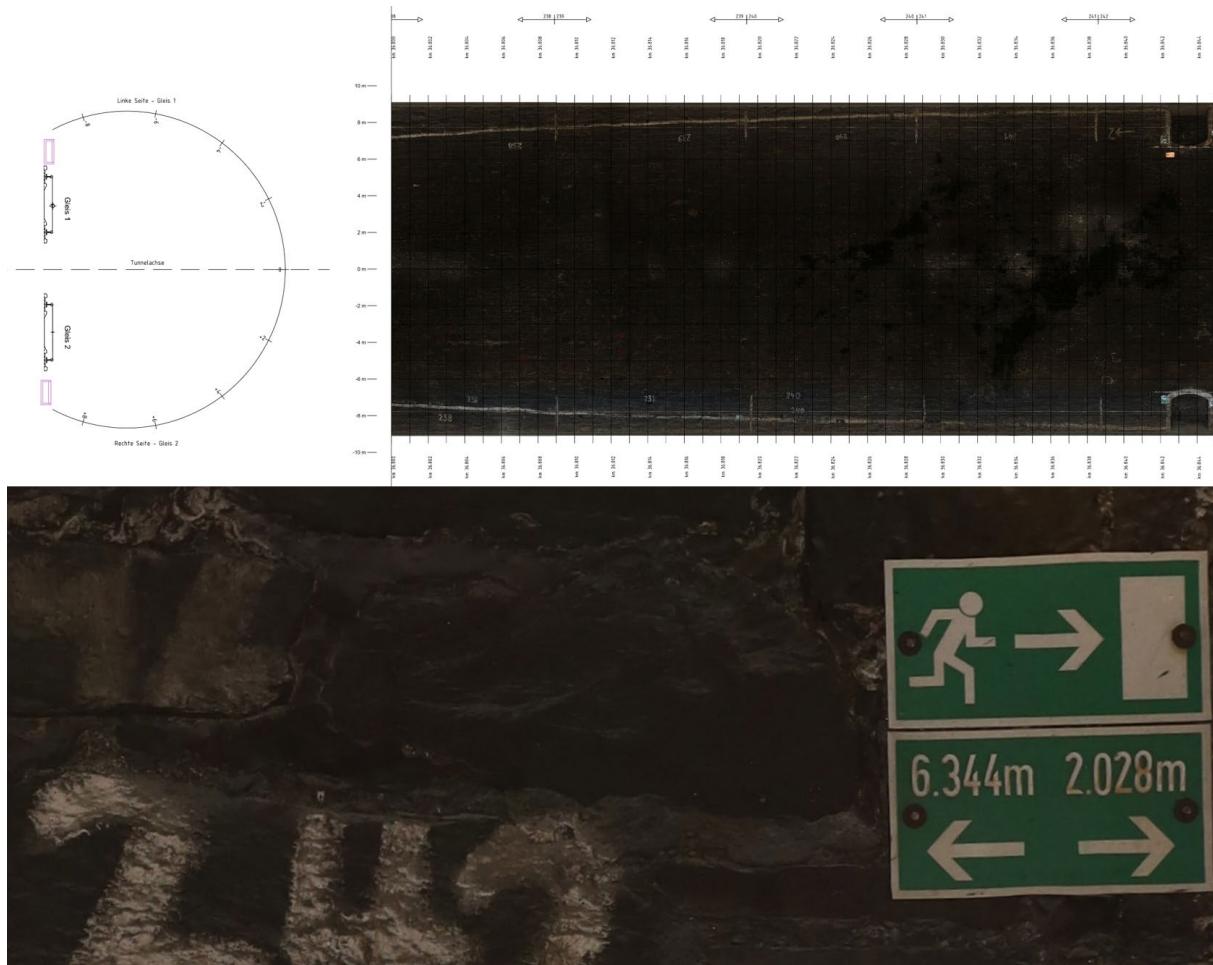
a) Orthobild der Tunneloberfläche – Ausschnitt Plandarstellung, b) Vergrößerung ca. 1.5 m Tunneloberfläche (VSP Stoltzka & Partner)
